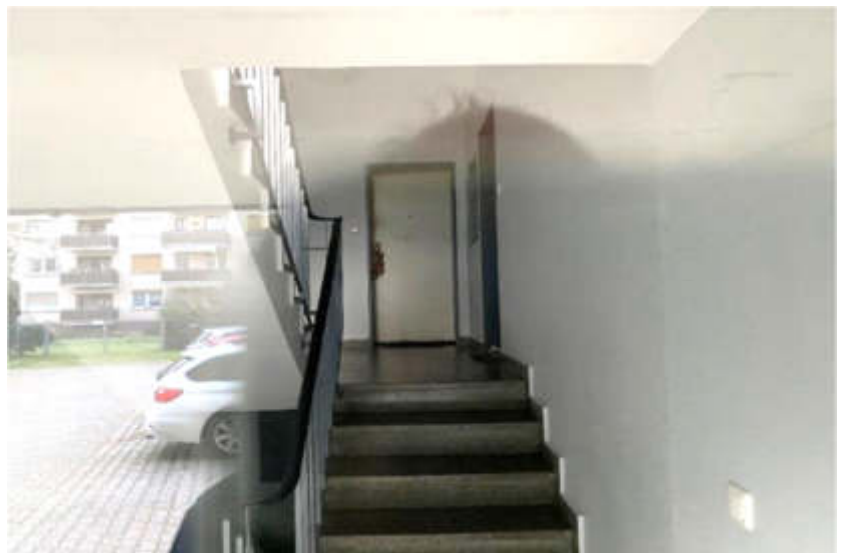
des SV: Treppenhaus Beethovenstraße 12; Wohnungseingang Nr. 26
